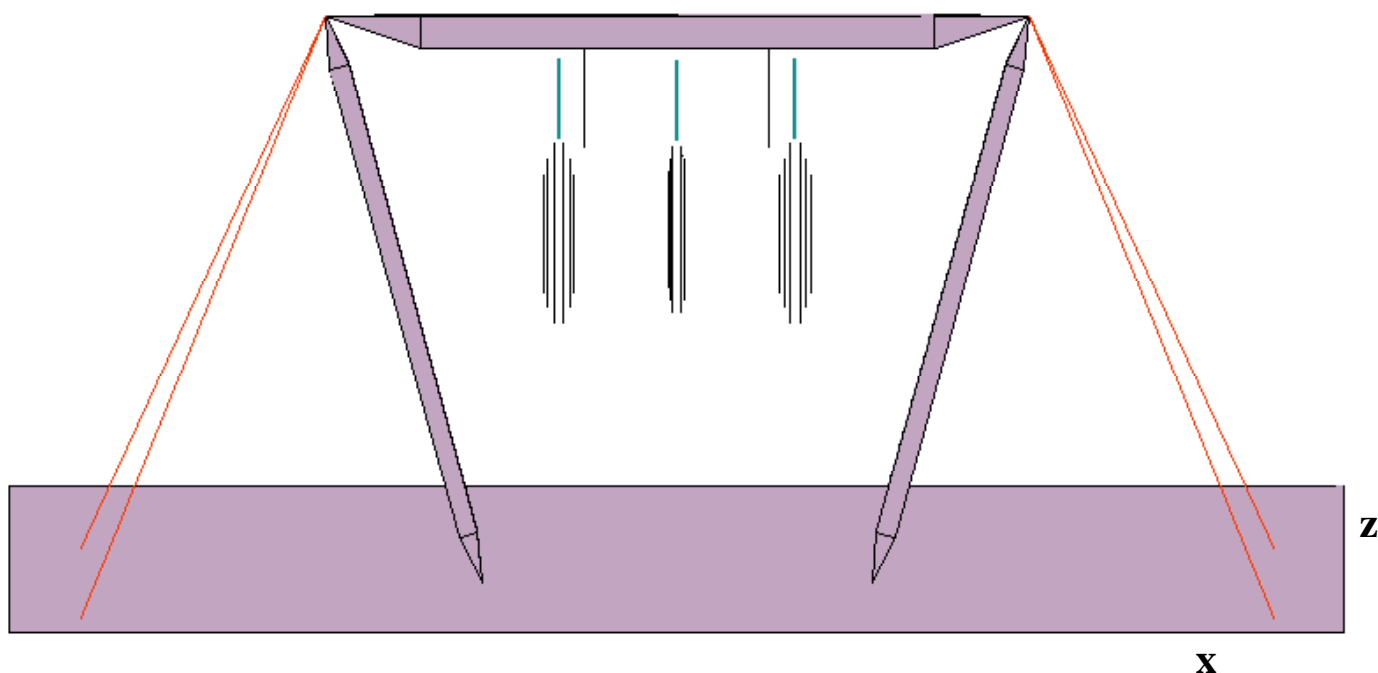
Disposição dos condutores e das estruturas estaiadas, na vizinhança de uma estrutura, a 25 °C, num vão de 500 m, em terreno plano, sem vento.
